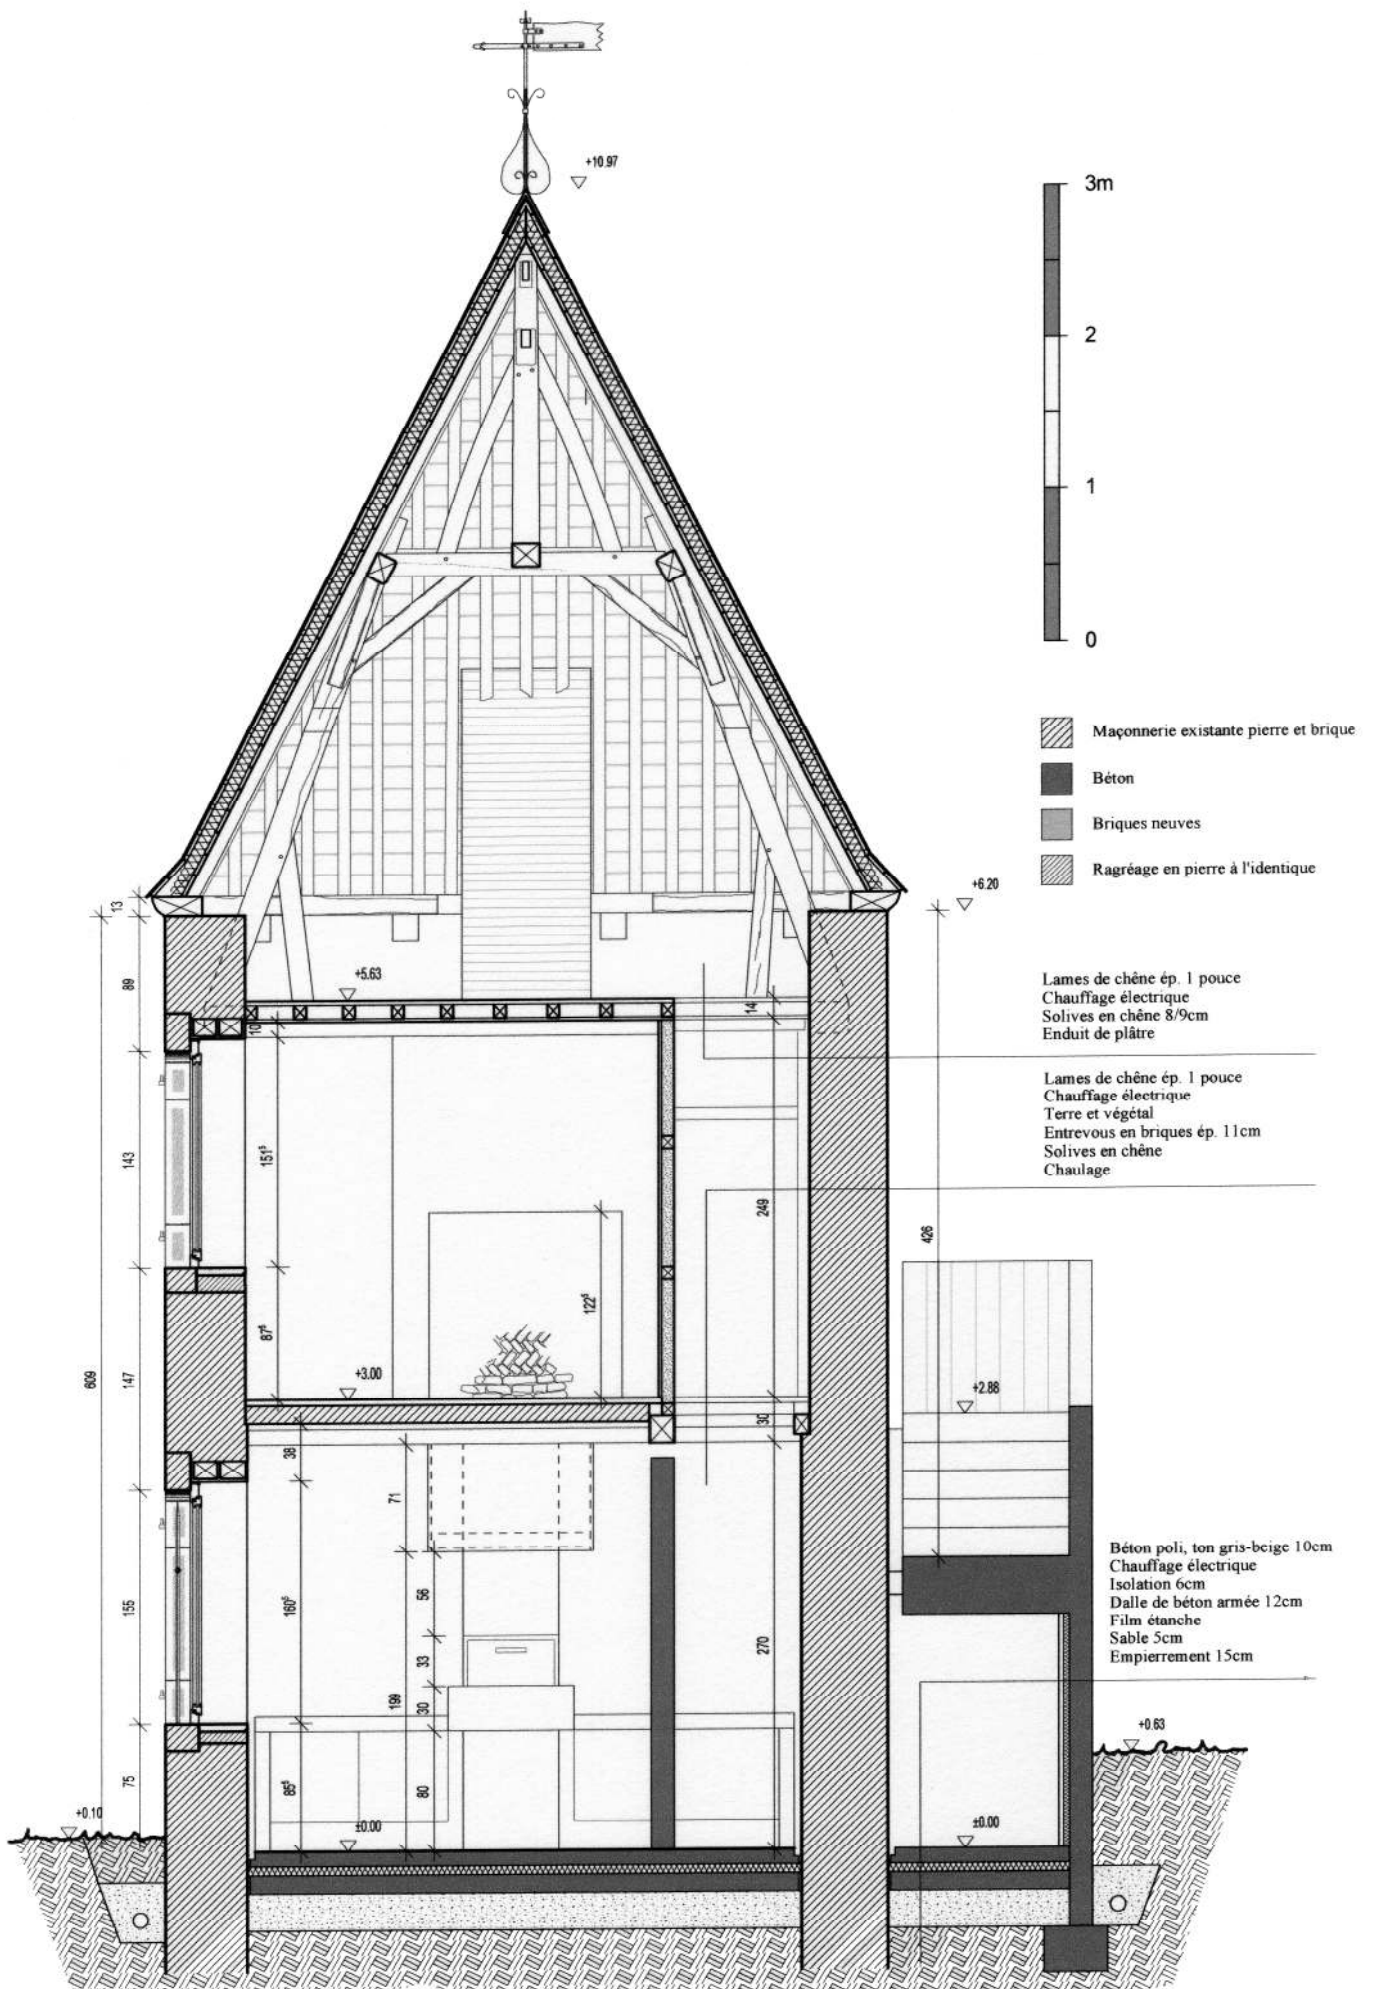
Pavillon et four. Vue en coupe AA'. Ech. 1/50°. Situation projetée. IG 2008.
